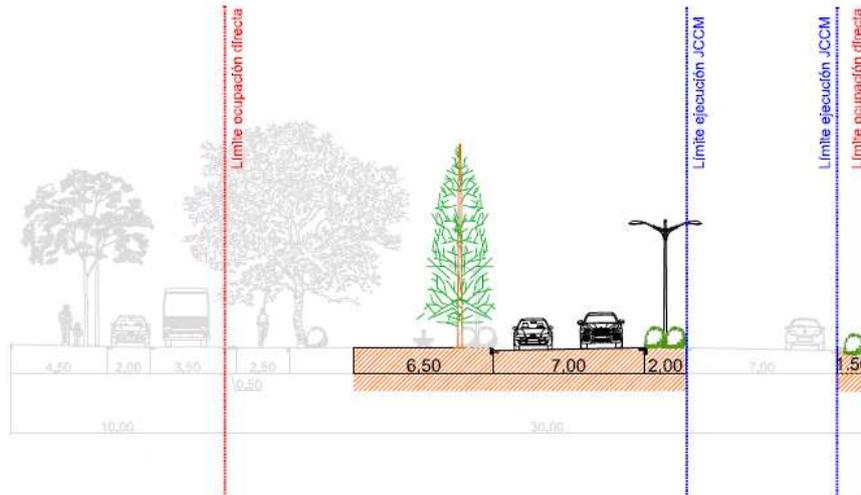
Sección tipo ejecutada. Fuente: Proyecto AB-20
